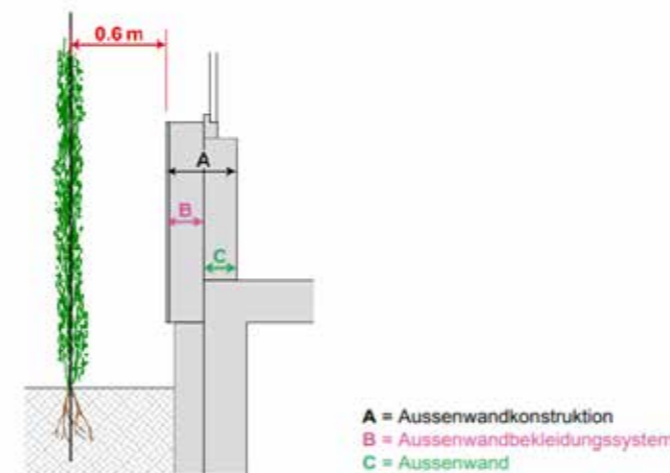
Mindestens 0.6 m Abstand von Ranksystem zur Aussenwandkonstruktion (© VKF Brandschutzmerkblatt Gebäudebegrünungen, 2024)
